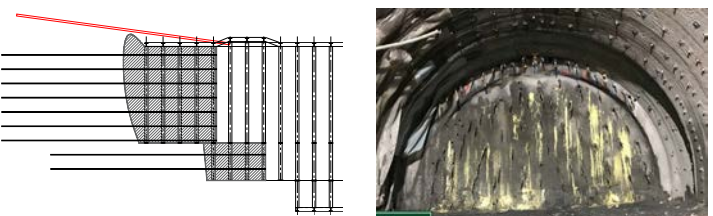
鏡ボルト, AGF 工の施工 写真-2 鏡ボルト, AGF 工の施工
